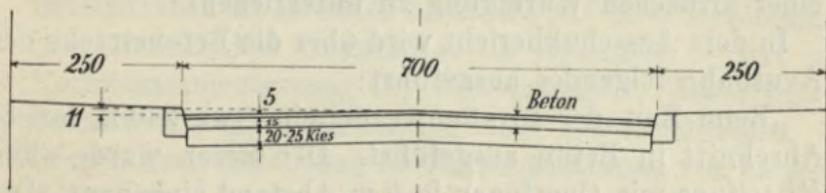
Betonstraße Wiesbaden-Biebrich (1905). Querschnitt.
